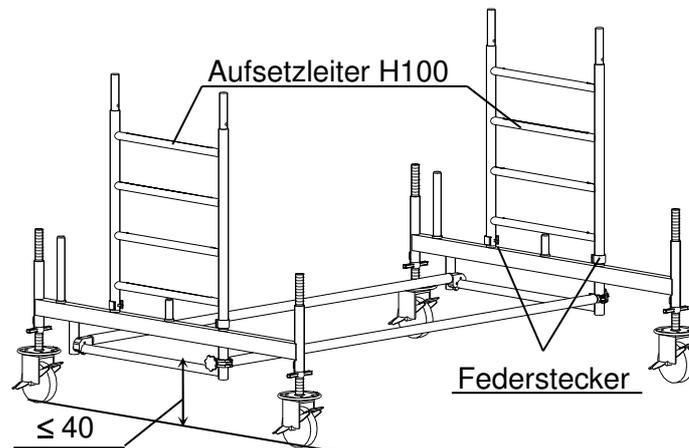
Grundeinheit mit Fahrbalken L180 – mittige Stellung
